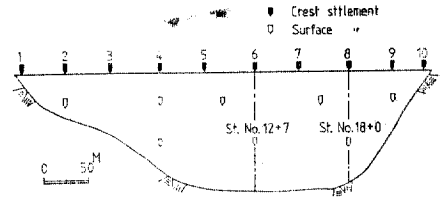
Instrumentation and Valley Profile-Longitudinal Section.
